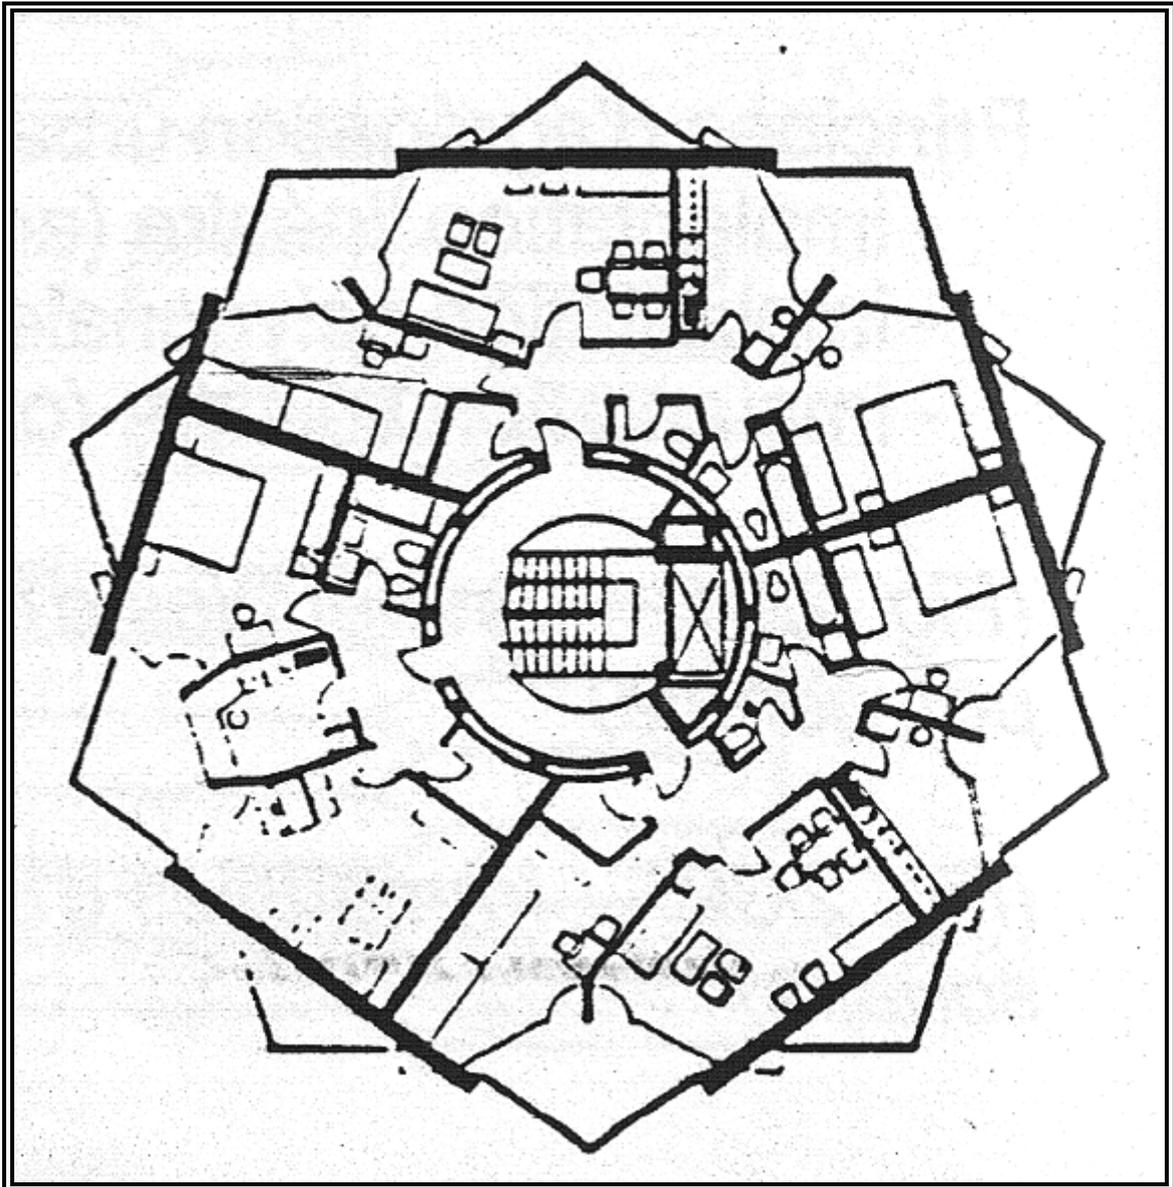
Immeuble d'habitation à desserte verticale et implantation solitaire.
